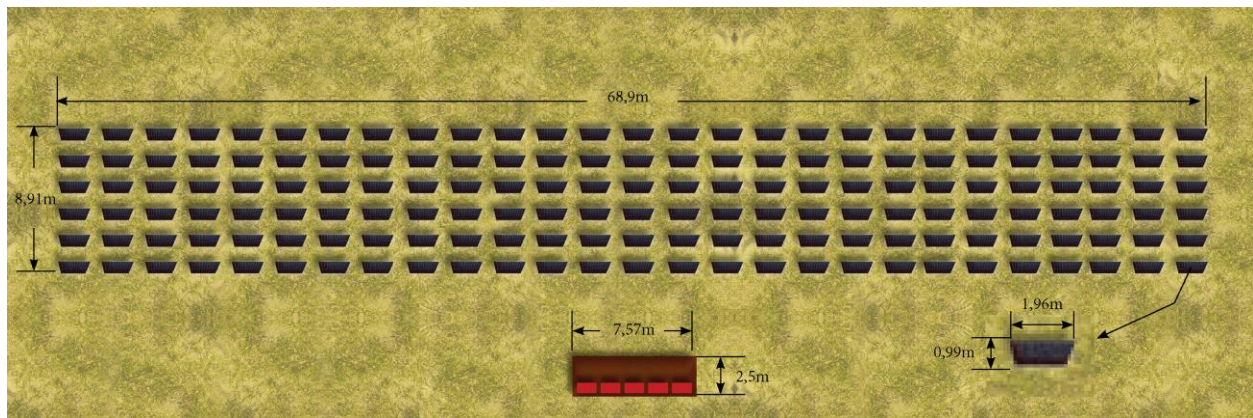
Layout Planta Fotovoltaica 100 kW. Fuente: Elaboración Propia.
